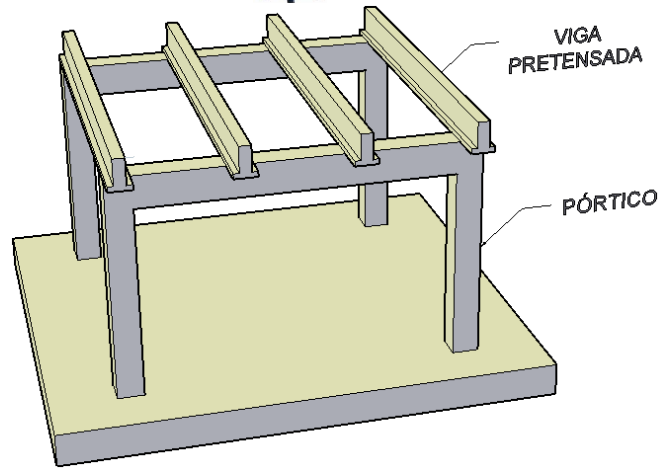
Vigas apoyadas sobre los pórticos o muros, luego de realizar el montaje.
